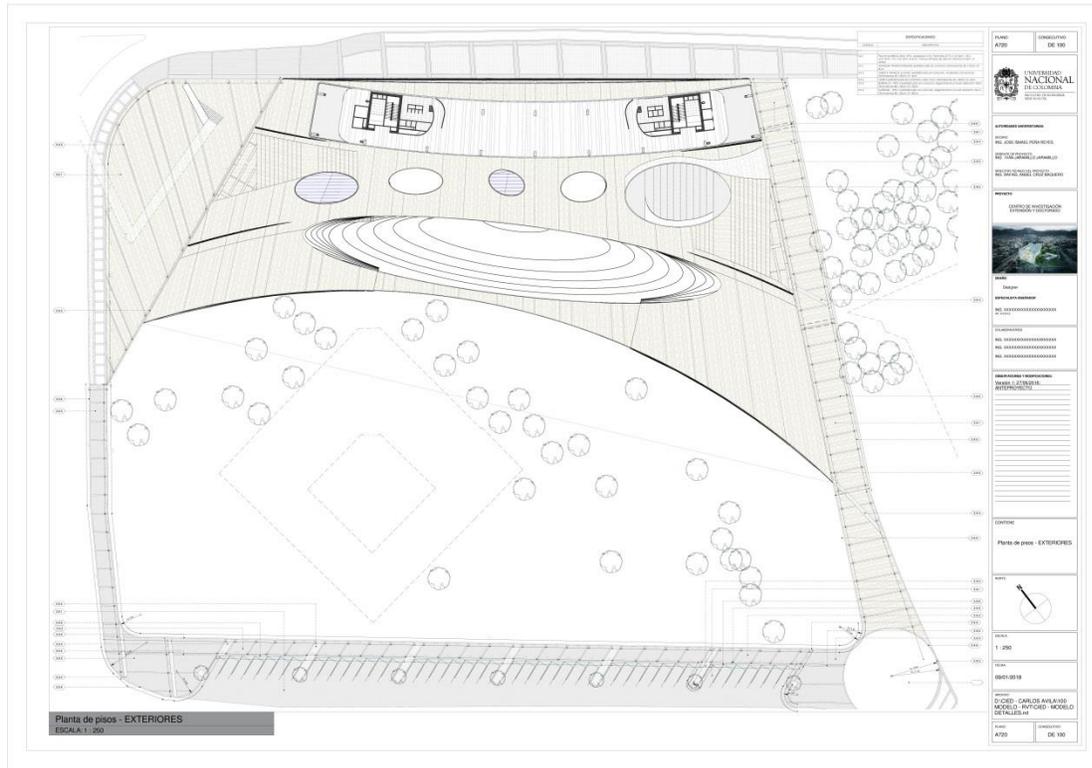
Proyecto arquitectónico edificio CIED, facultad de ingeniería
